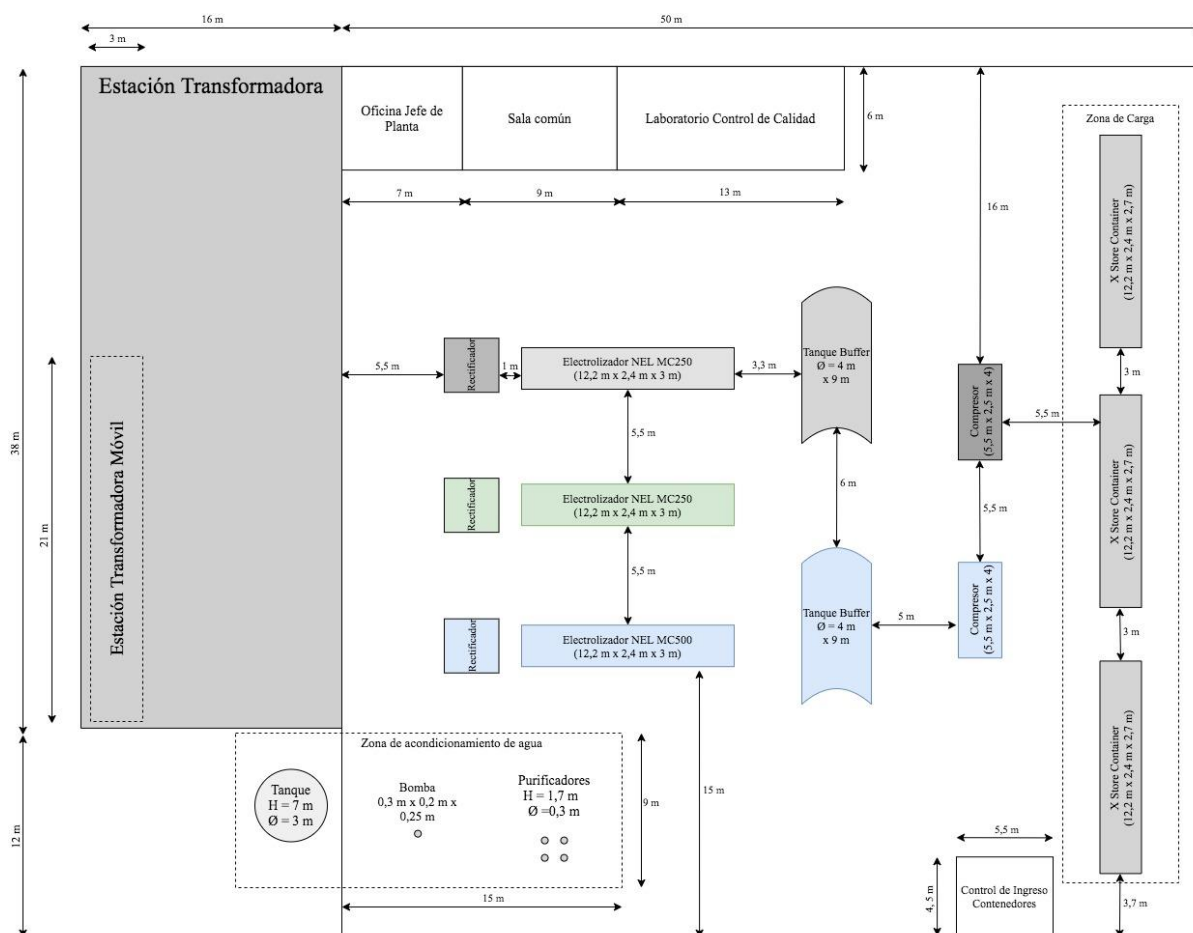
Plano de Planta de Producción de Hidrógeno.
